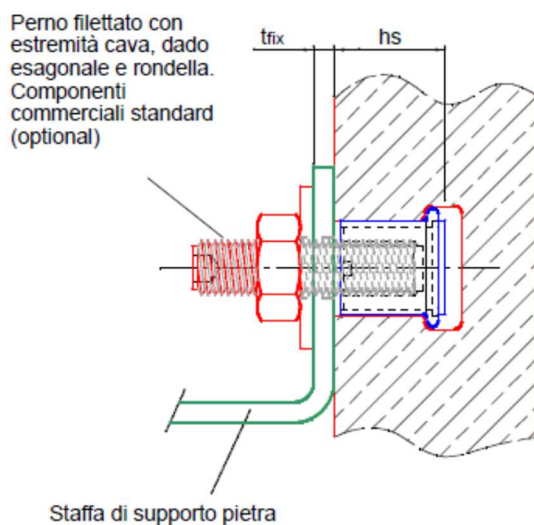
Uso previsto dell'ancorante GSD: collegamento con staffa/sottostruttura metallica
